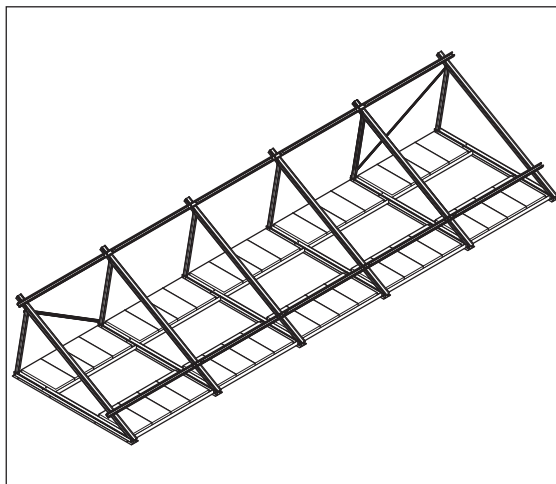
Exemple d'une ossature pour toit-terrasse pour 5 capteurs plans (EKSV26P)
